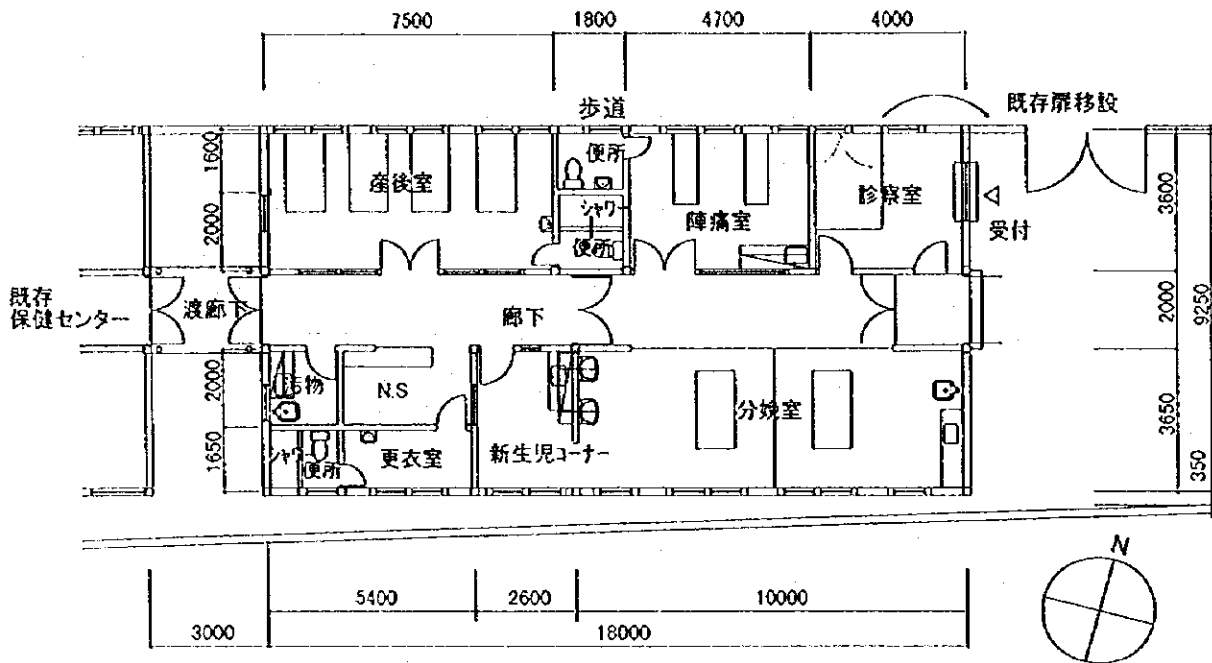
ピエドラ・リサ保健センター分娩棟平面図
